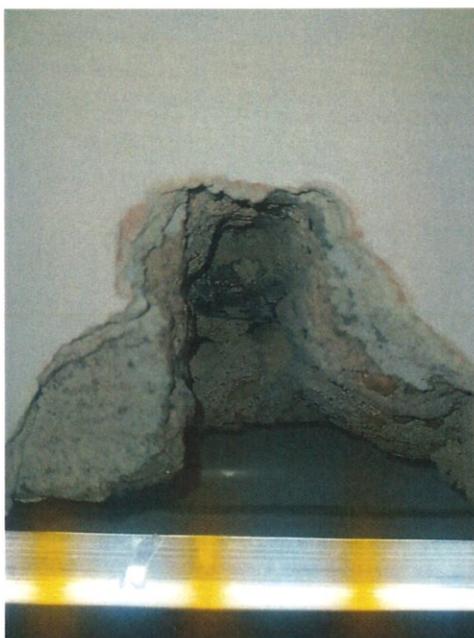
Участок балки перекрытия первого этажа. Вскрытие 2.
